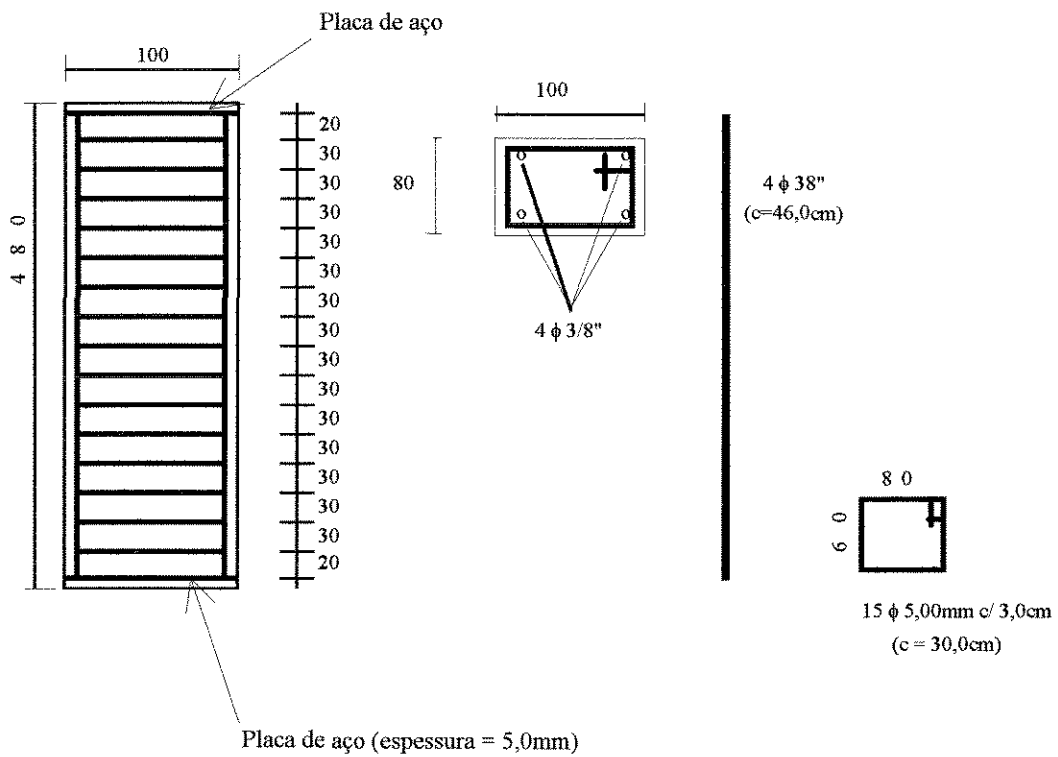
Detalhamento das armaduras dos pilares P8/10-200 e P8/10-225
